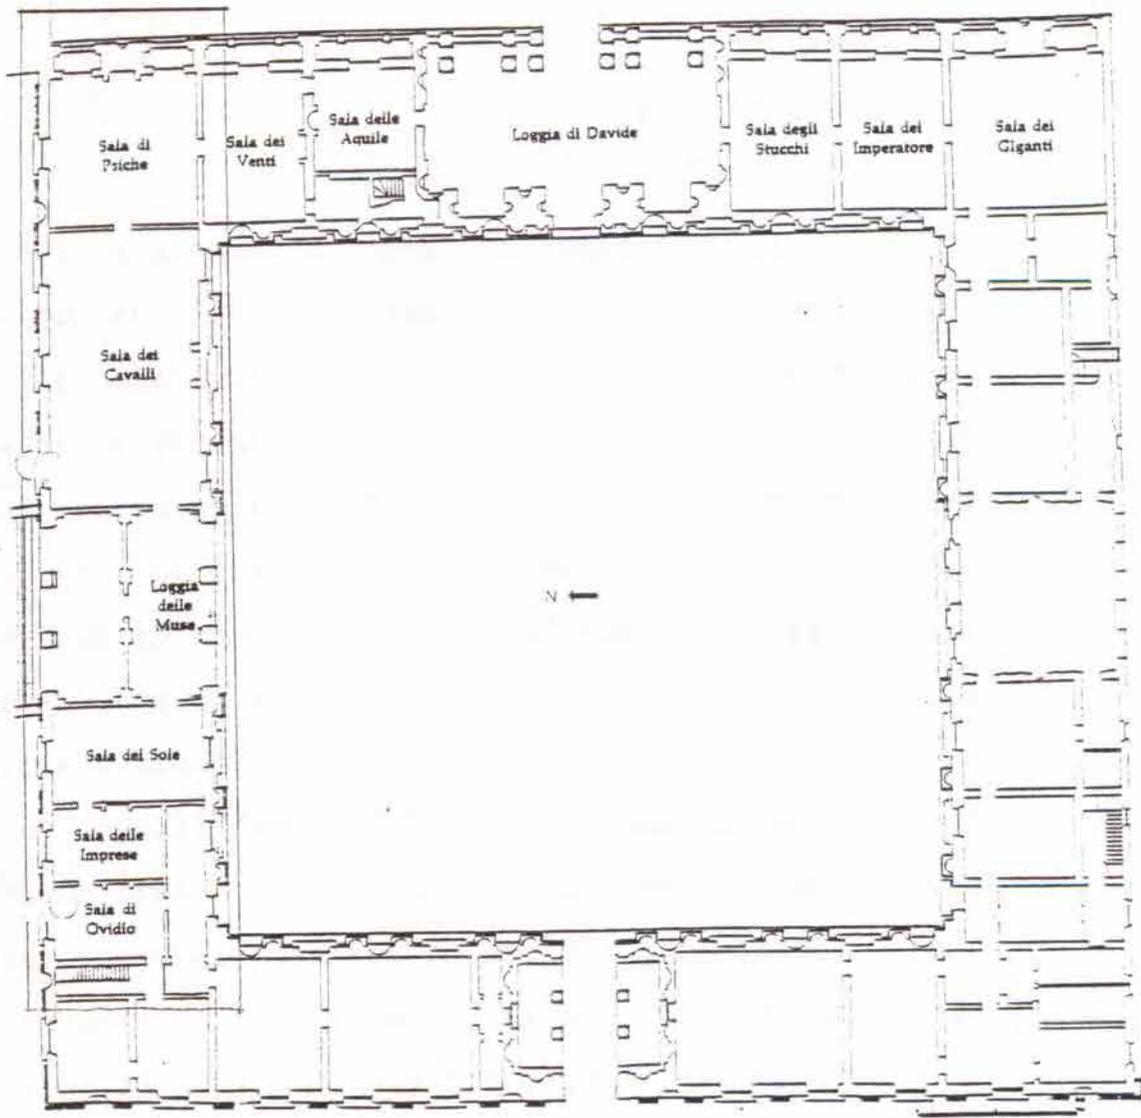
Palazzo del Te. Planta baja. En el recuadro lo que constituía la villa.
